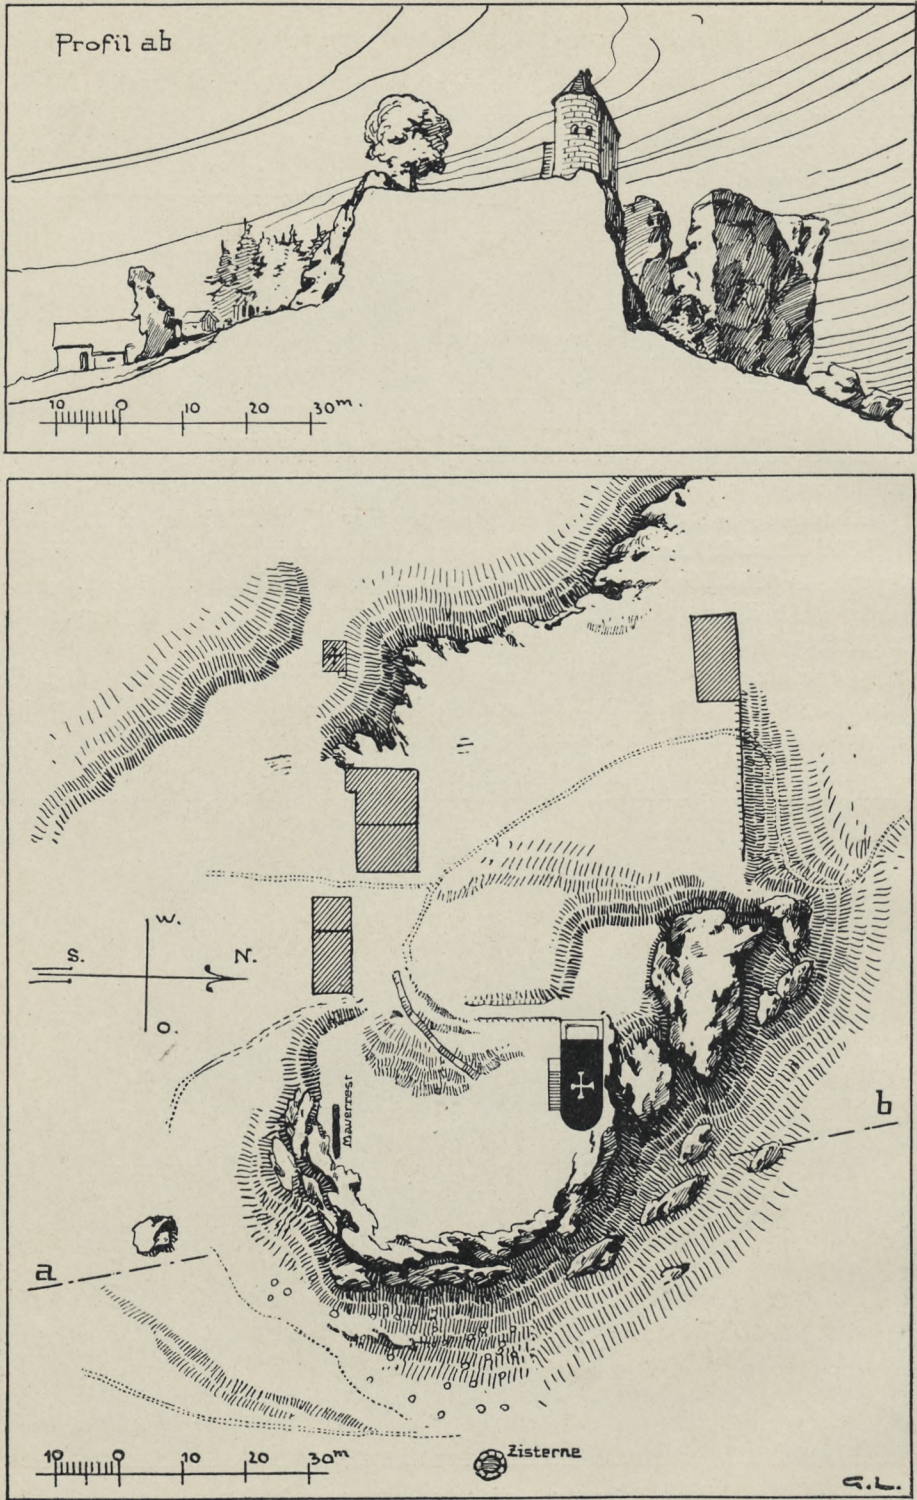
Breitenstein. Grundrisskizze und Profil des Burgstalles.
